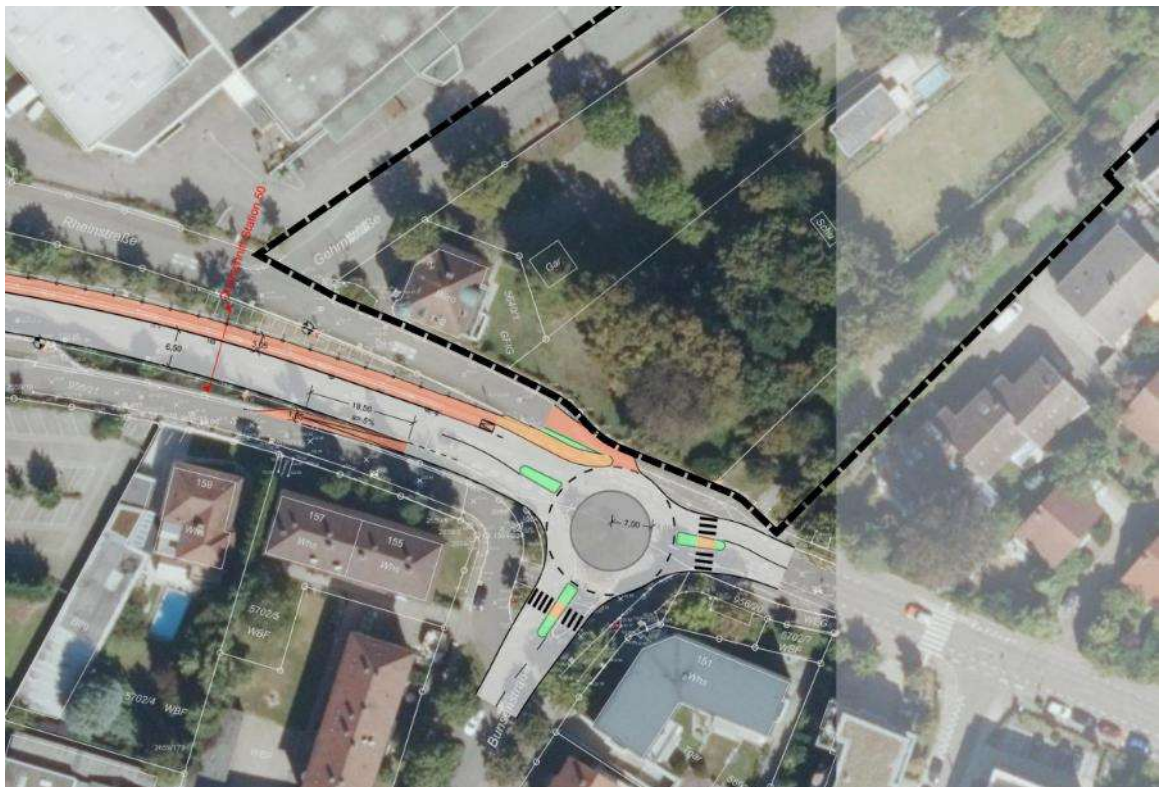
Planung Kreisverkehr mit Geltungsbereich Bebauungsplan (Quelle: Koehler & Leutwein, eigene Ergänzung)
